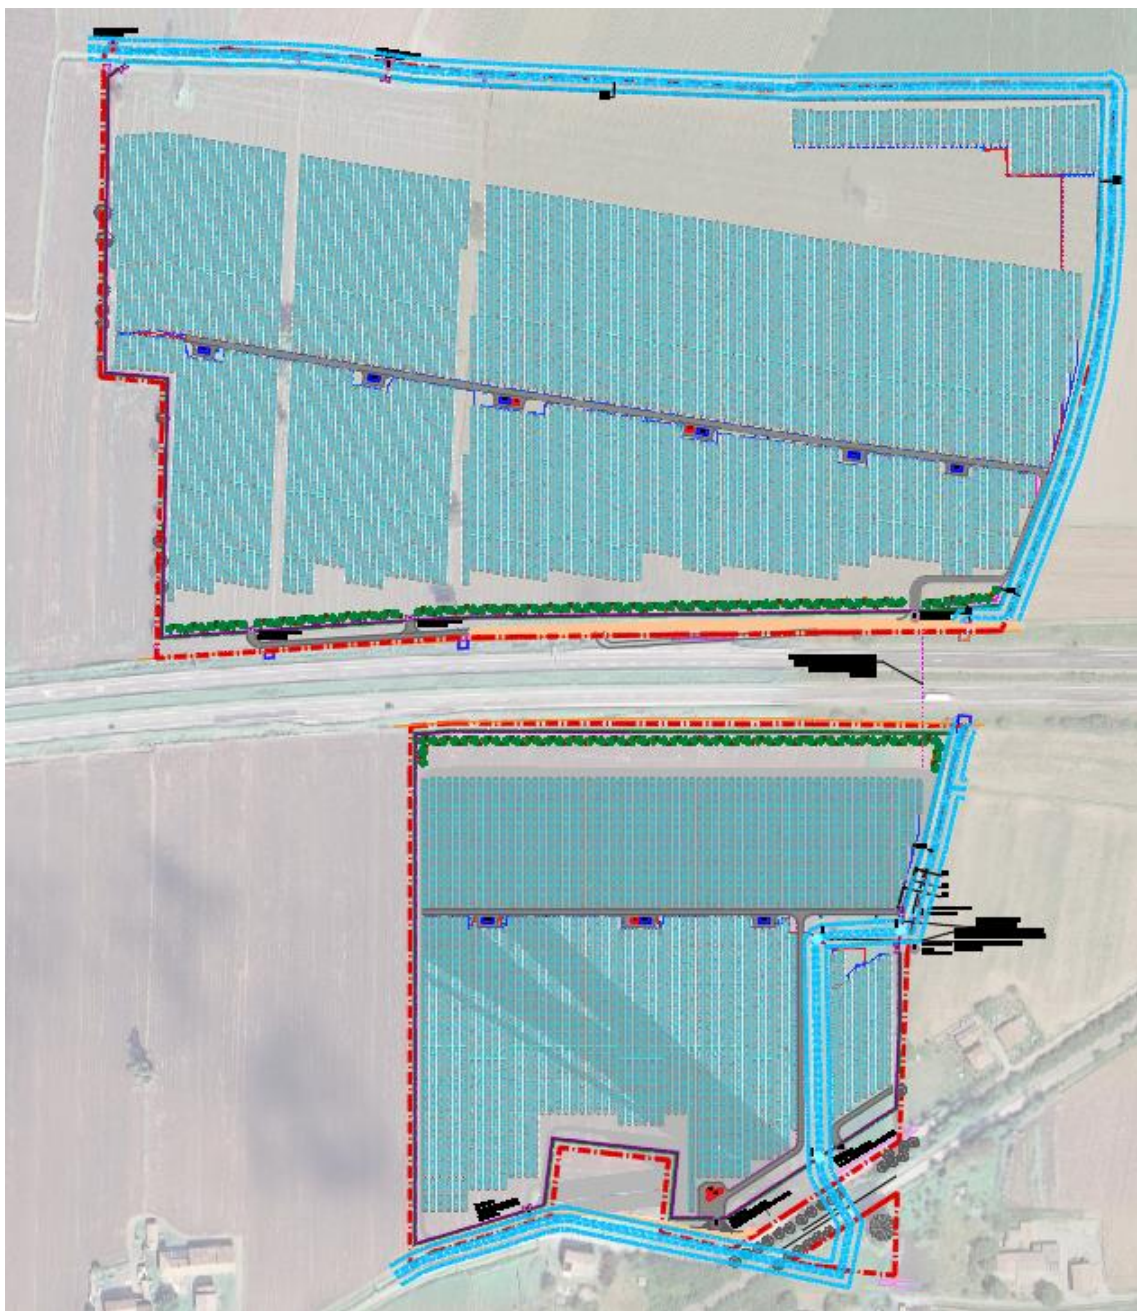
Planimetria dell'area d'impianto (fonte: tavole di progetto)
